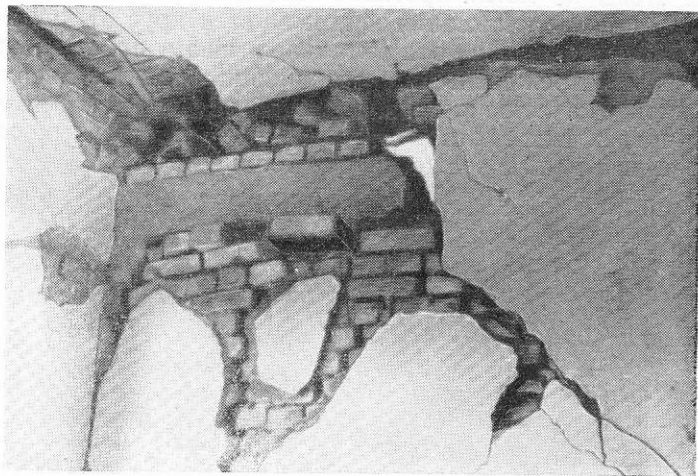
Разрушение кирпичной кладки в местах примыкания поперечных стен к продольным
